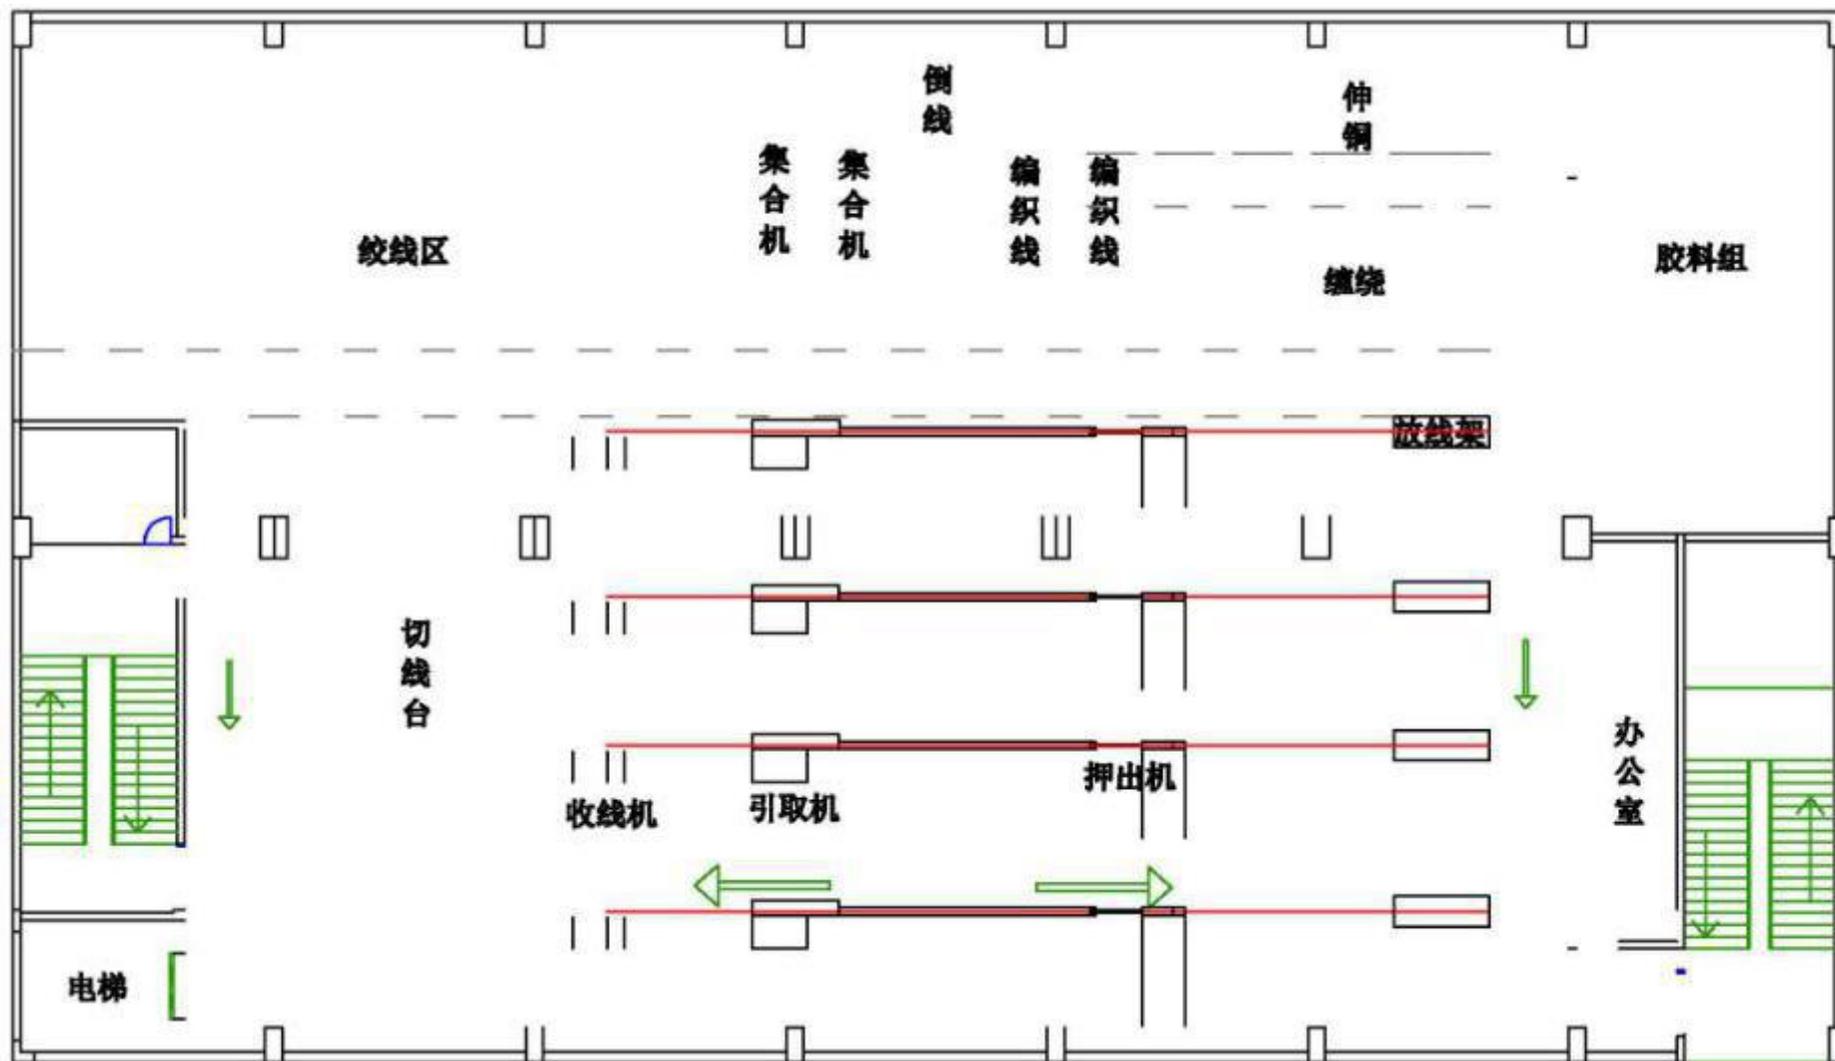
厂房平面布置图（电线制造车间，E 栋二层）
